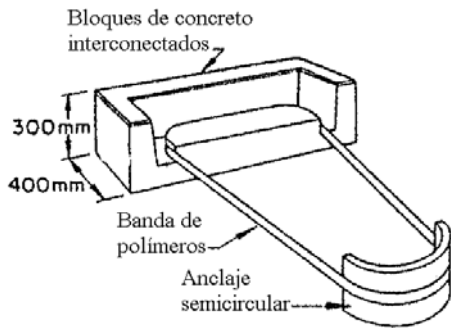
Muro con bloques de concreto, tiras de polímeros y anclajes. (O'Rourke & Jones, 1990).
